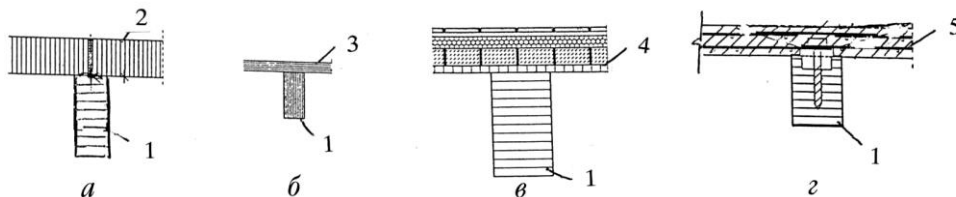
Варианты ребристых покрытий: 1 – клеодощатые или склеенные из шпона балки; 2 – деревоплита составного сечения из пакета досок или брусьев; 3 – плита, склеенная из шпона; 4 – комплексная деревоплита; 5 – железобетонная плита
